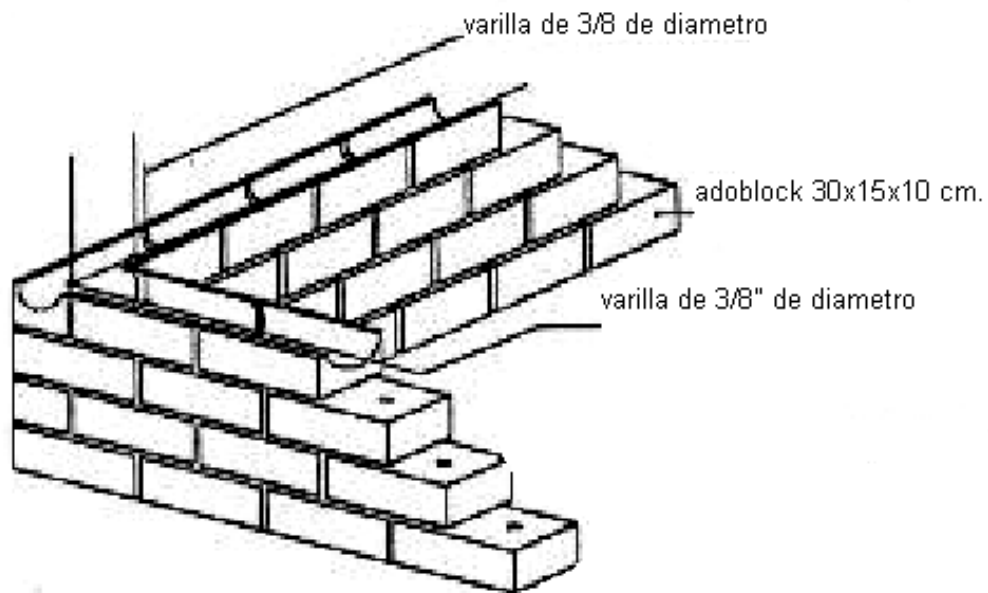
Detalle de colocación de refuerzo en paredes de adoblock.
